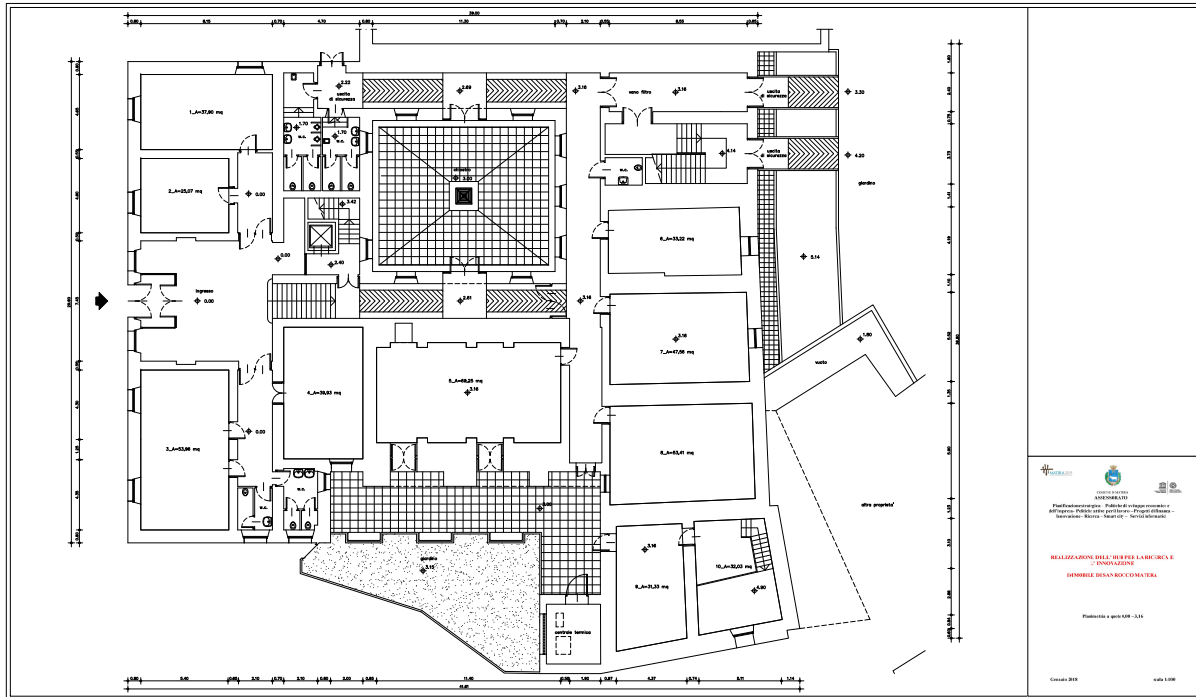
Planimetria dell'ex-ospedale di San Rocco
